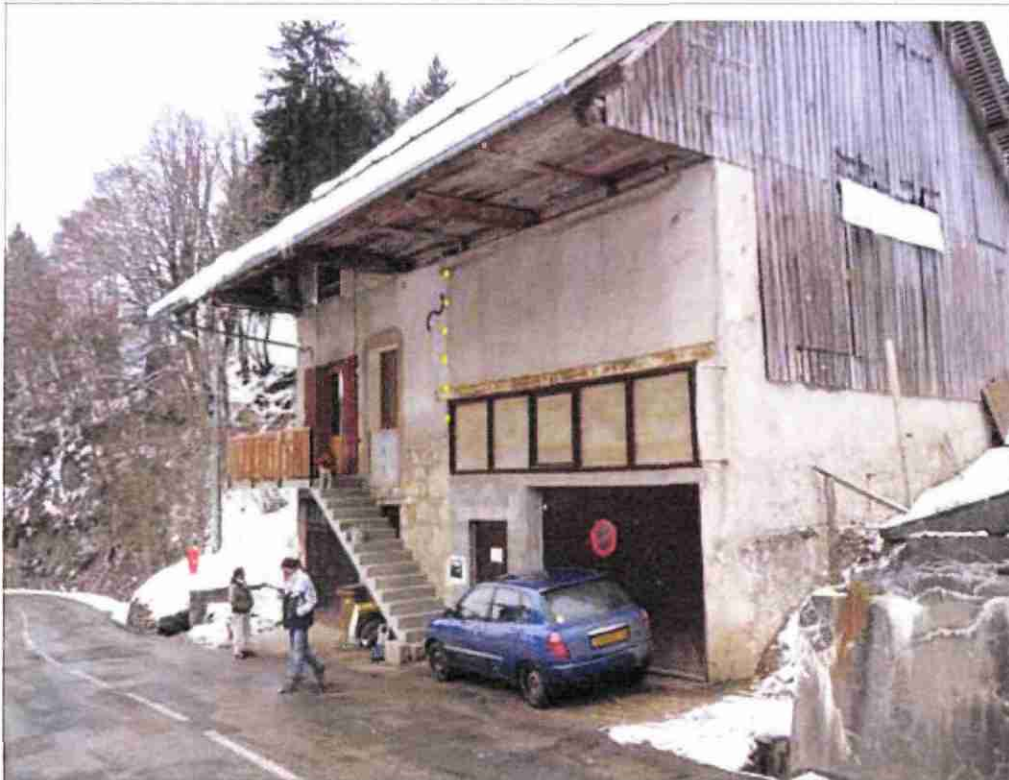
localisation de la fissure en façade sud-est
